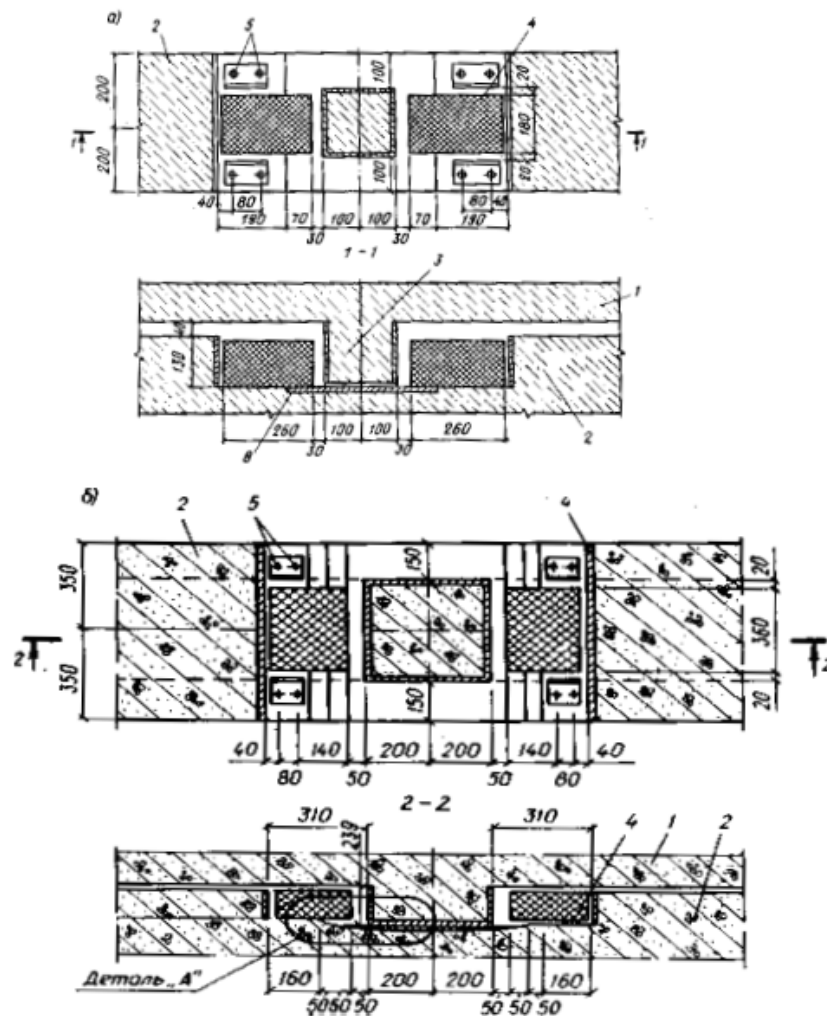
Конструкция скользящих опор совмещенного типа: а – для пятиэтажных зданий с горизонтальной нижней пластиной; б – для девятиэтажных зданий с наклонной нижней пластиной; 1 – железобетонный ростверк; 2 – упор; 3 – скользящая опора; 4 – упругий ограничитель горизонтальных перемещений (демпфер); 5 – жесткий ограничитель горизонтальных перемещений (упор).
